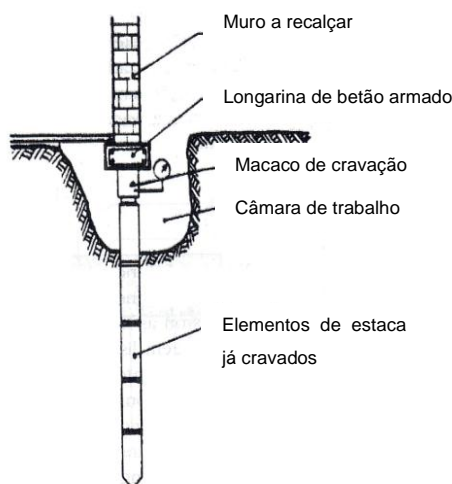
REFORÇO DE FUNDAÇÕES DE SAPATA CORRIDA ACESSÍVEL SOMENTE DE UM LADO [4].
